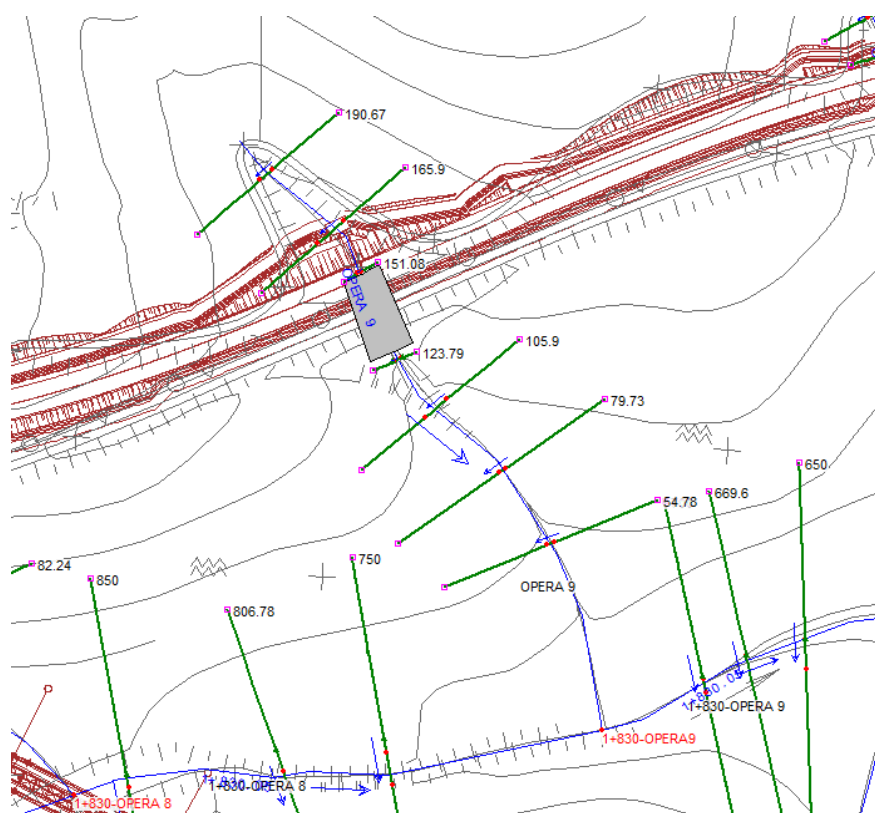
Planimetria Hec ras – sovrapposizione SDF – linea di progetto
